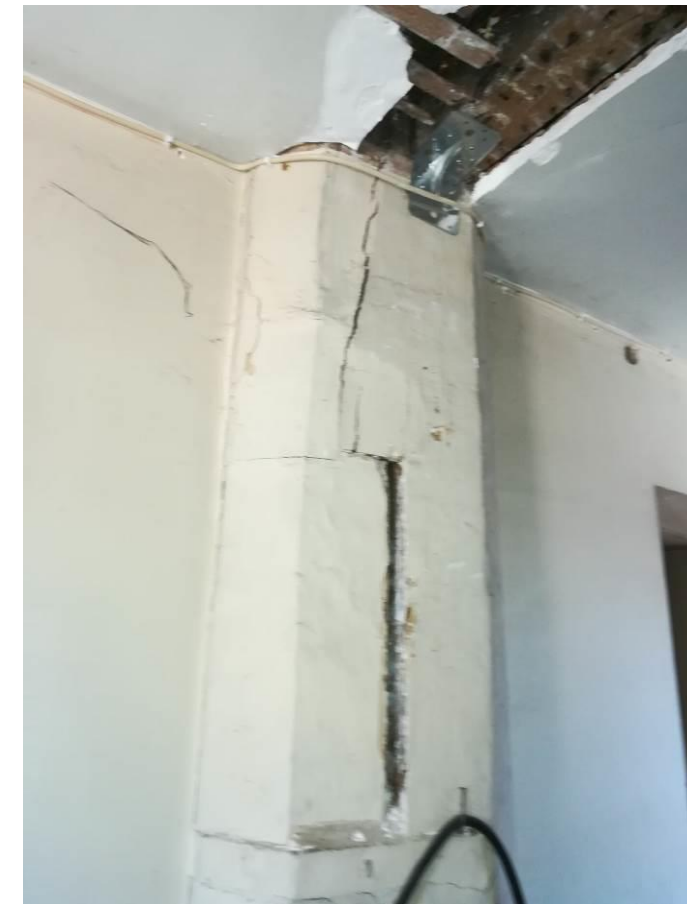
Vue de l'un des poteaux en chêne de la structure d'origine du Jeu de paume
